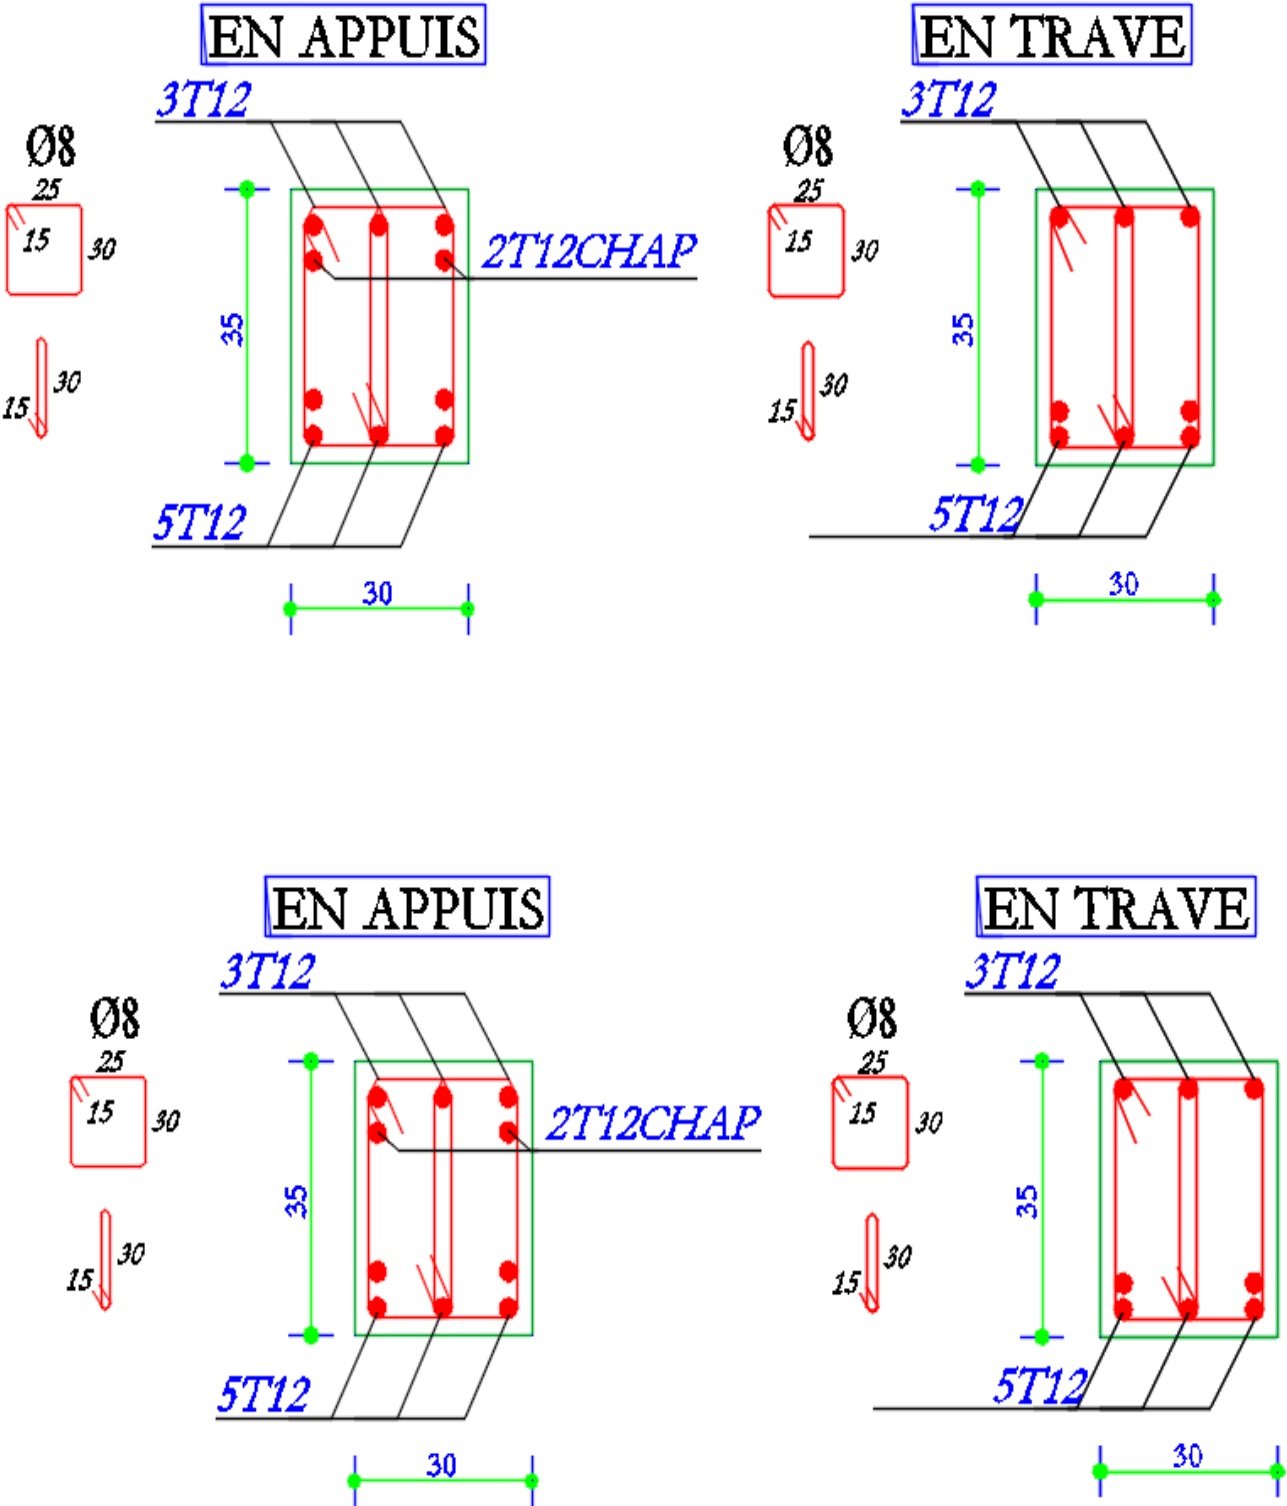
Schéma de ferrailage des poutres secondaires dans les déférents étages.
